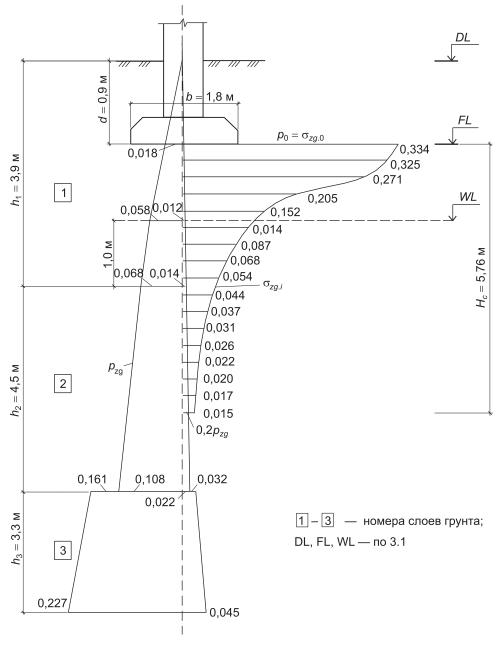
Расчетная схема основания фундамента к примеру Г.7
